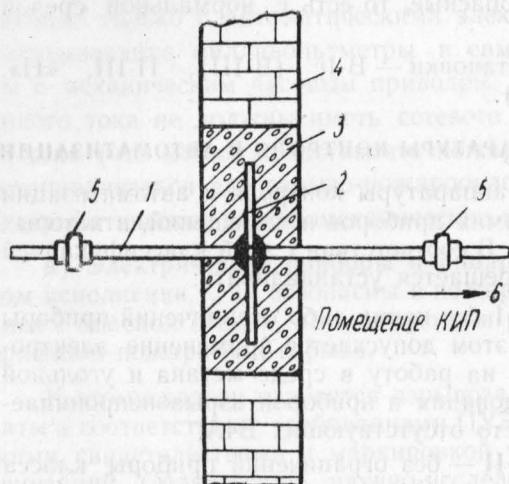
Схема заделки импульсных труб в стенах помещения КИП
